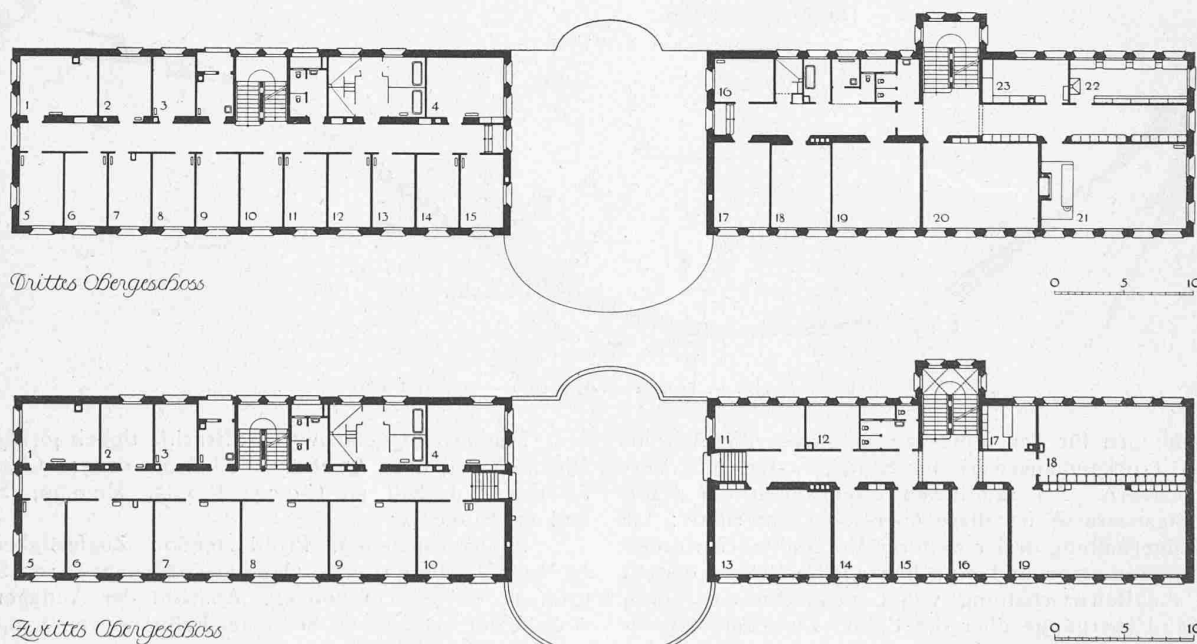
und 6. Grundrisse des Hochalpinen Töchterinstituts Fetan im Unterengadin. — Masstab 1:500.
